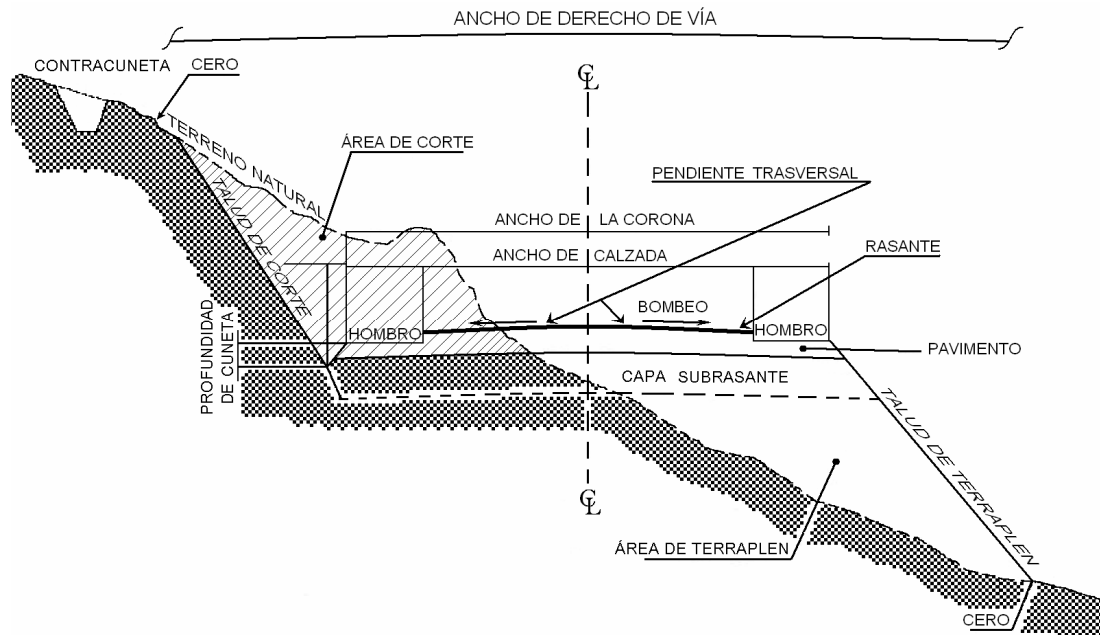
Elementos que integran una sección transversal de una carretera.
